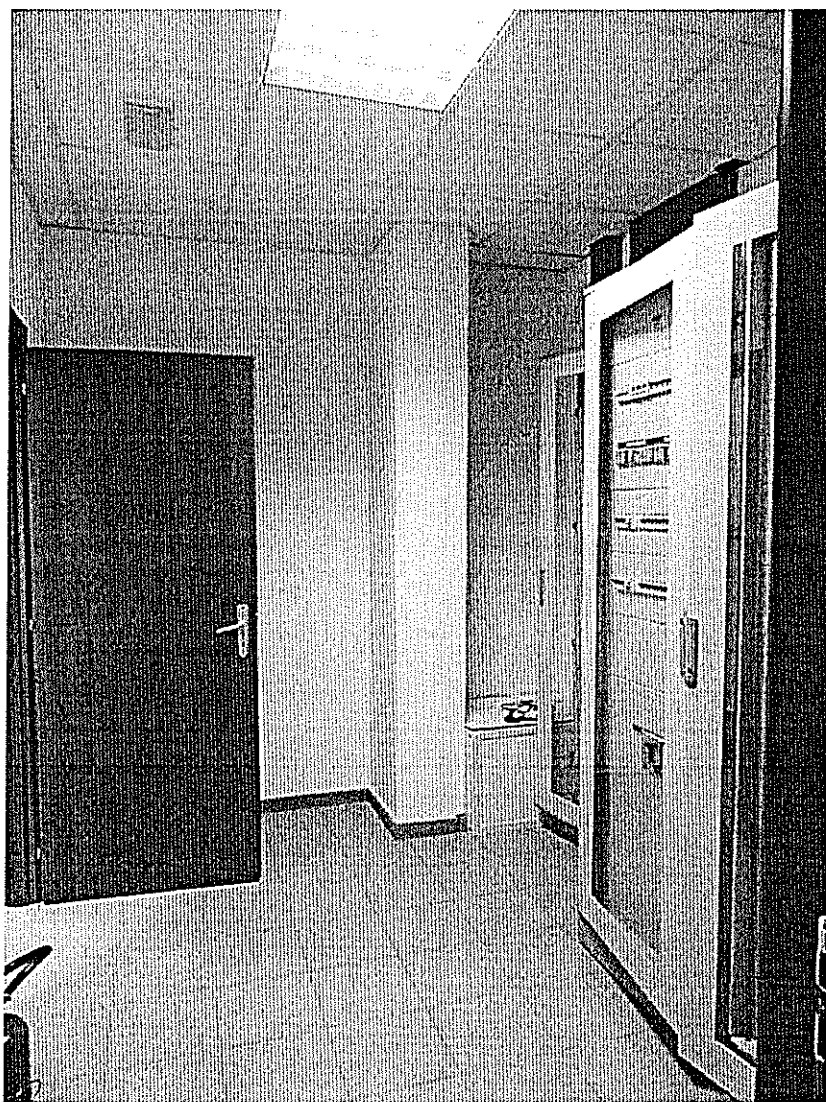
Locale deposito del primo corpo di fabbrica – piano terra.
